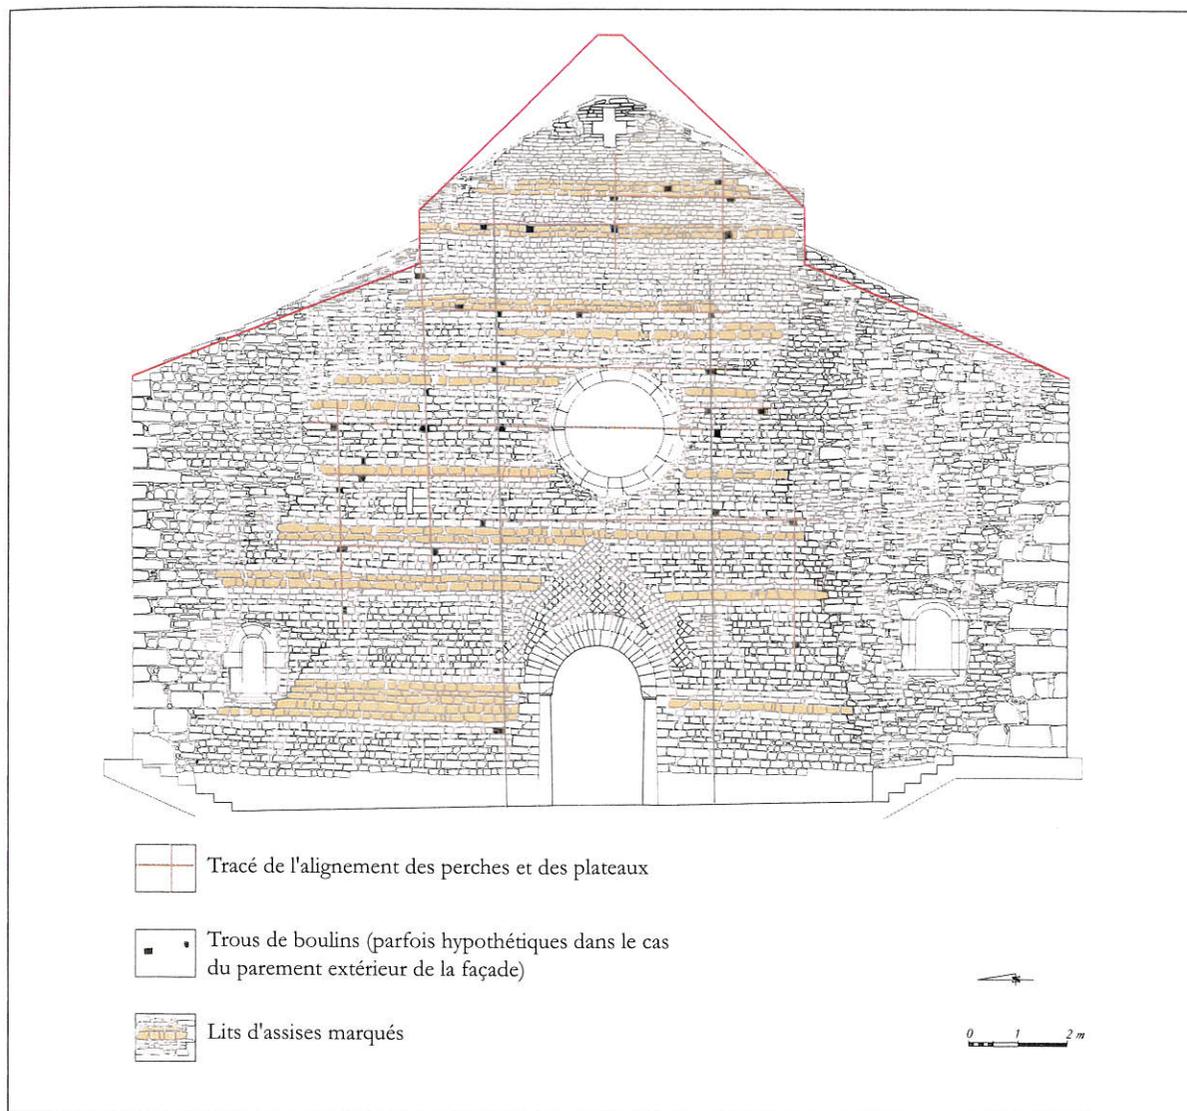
Saint-Lupicin, façade occidentale, relevé pierre à pierre du parement extérieur et restitution de l'échafaudement (dessin L. Fiocchi d'après S. Bully, APAHJ-UMR ArteHis, Dijon)
